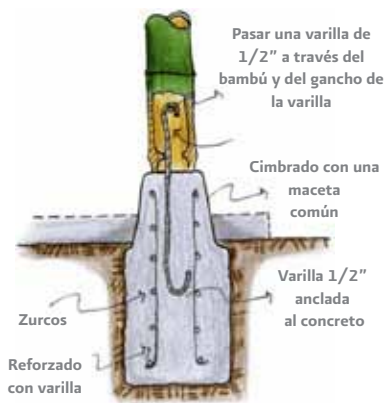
Anclaje de columnas, pies derechos y verticales a la cimentación con varilla de refuerzo y pasador.
